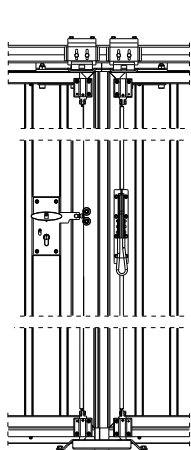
Блокировка двухпольных ворот (DW) – вид с внутренней стороны.
